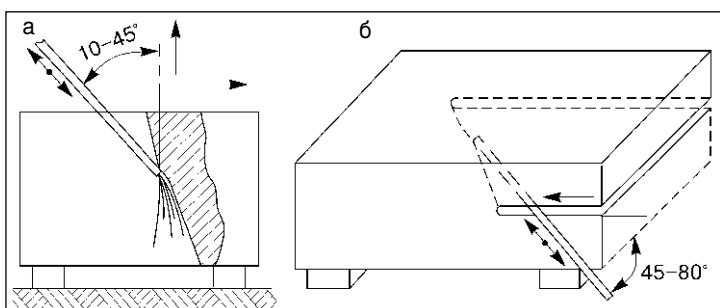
Резка бетона и железобетона толщиной до 300 мм:
